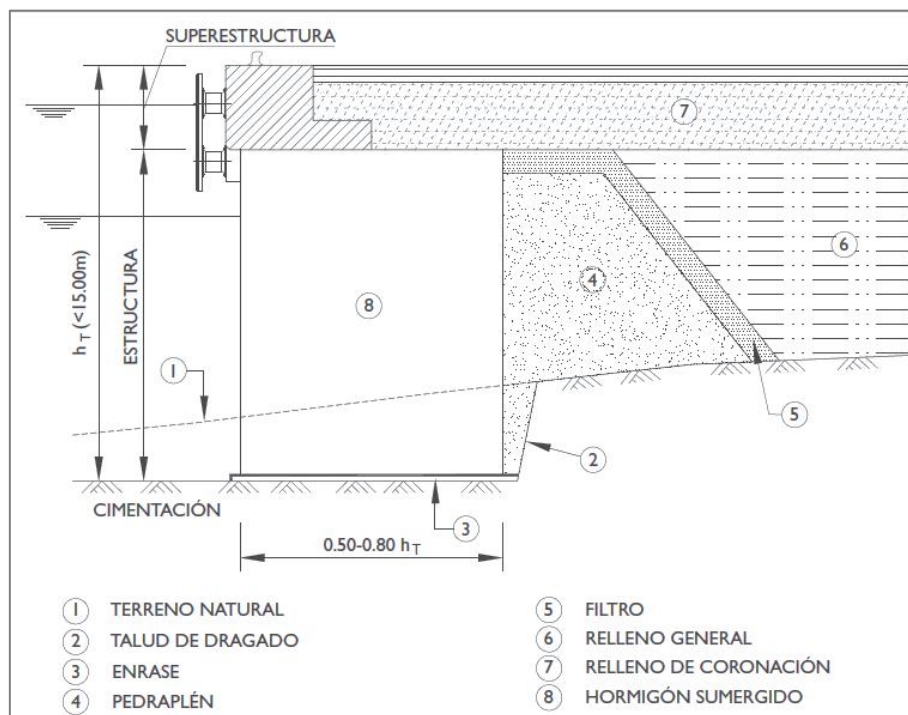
Muelle de hormigón sumergido (ROM 2.0-11)
